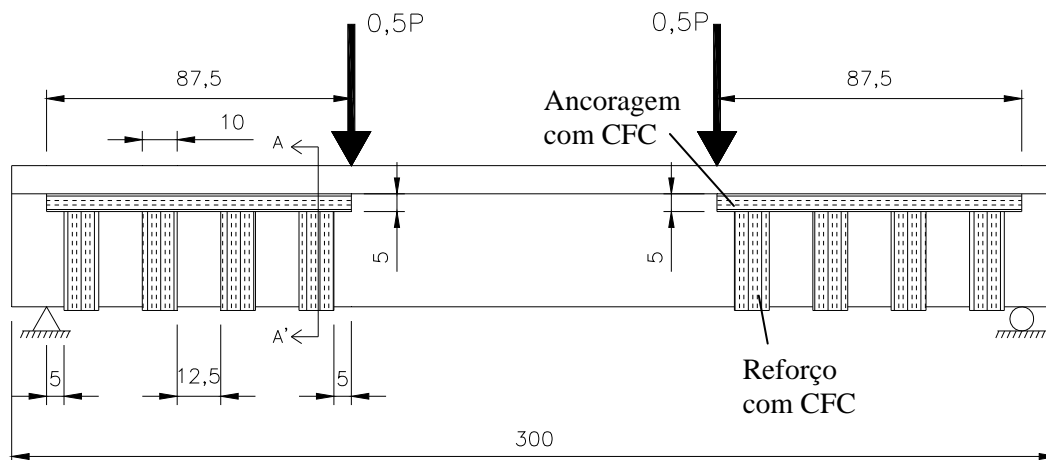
Esquema longitudinal da colagem do reforço em CFC (cotas em cm).
